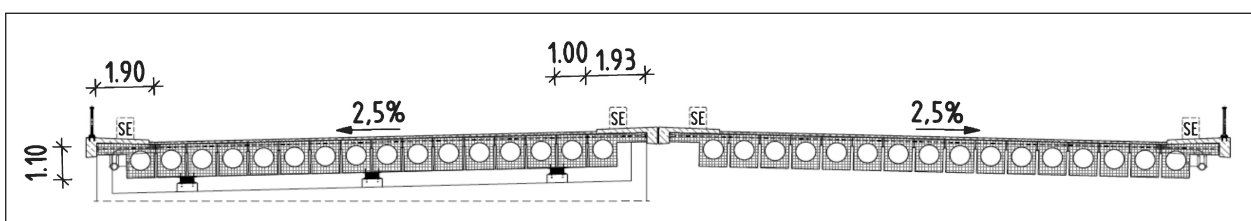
Spannbetonhohlkästen mit einbetonierten Rohren
